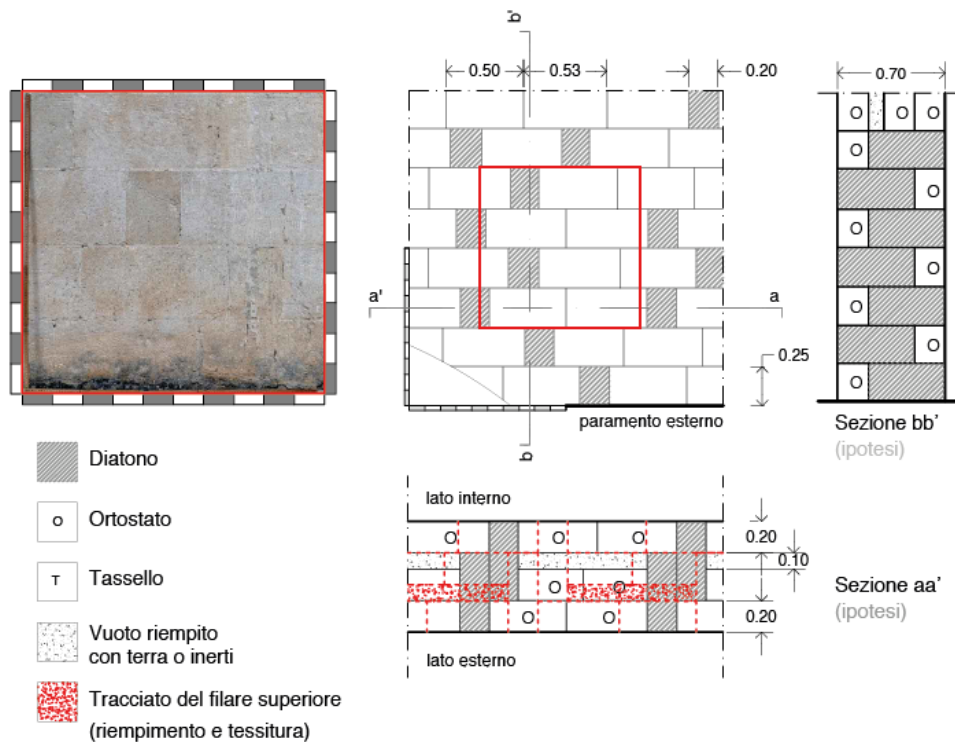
Analisi delle tessiture murarie di Palazzo Lanfranchi. Elaborazione grafica del prospetto a vista, ipotesi della tessitura interna (pianta e sezione)
